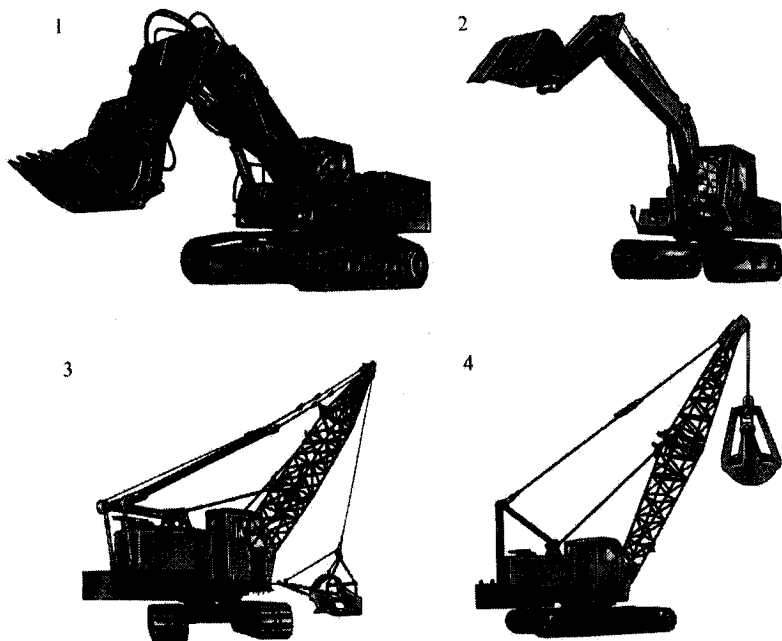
Загальний вигляд одноковшового екскаватора:
